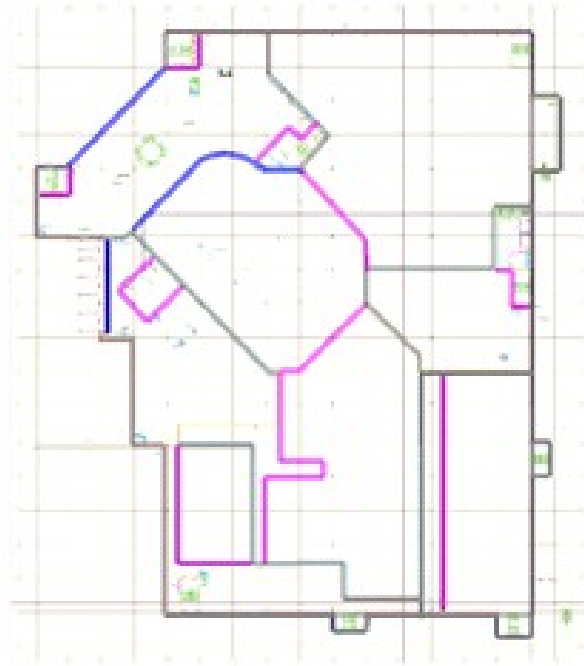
План приміщень 4 поверху. Стіни та перекриття 4 поверху
